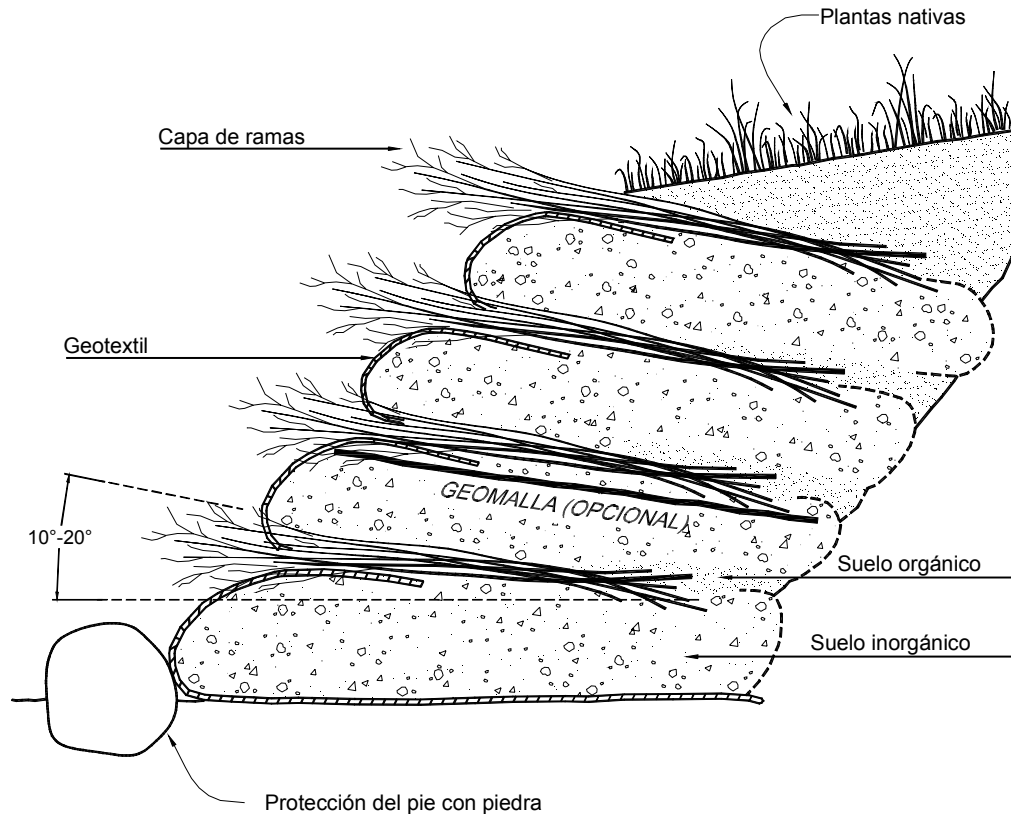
Capas de ramas utilizando geotextil (McCullah, 2001).
